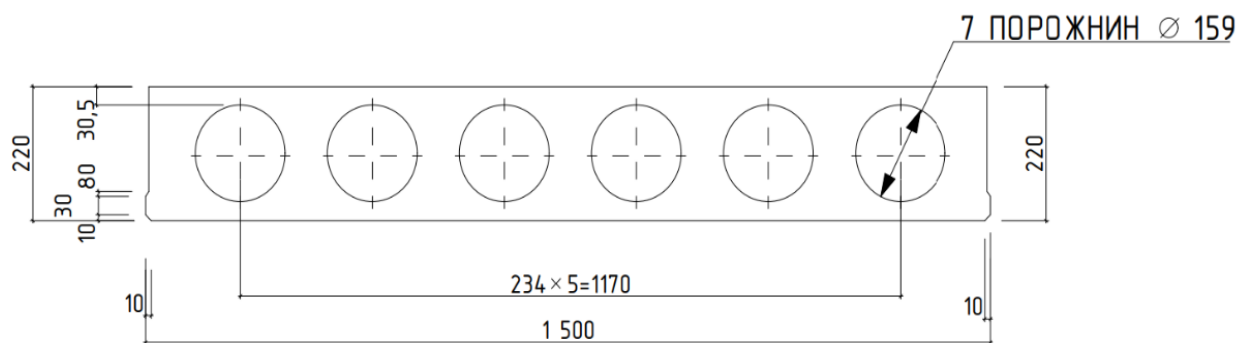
Поперечний переріз багатопустотної плити перекриття
